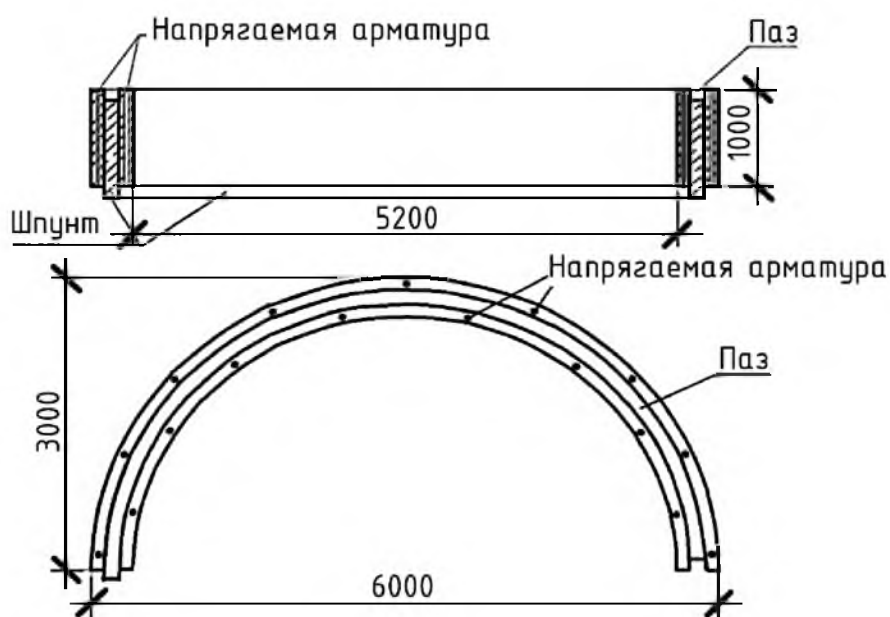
Железобетонное полукольцо со шпунтованным (пазогребневым) соединением (пример)
